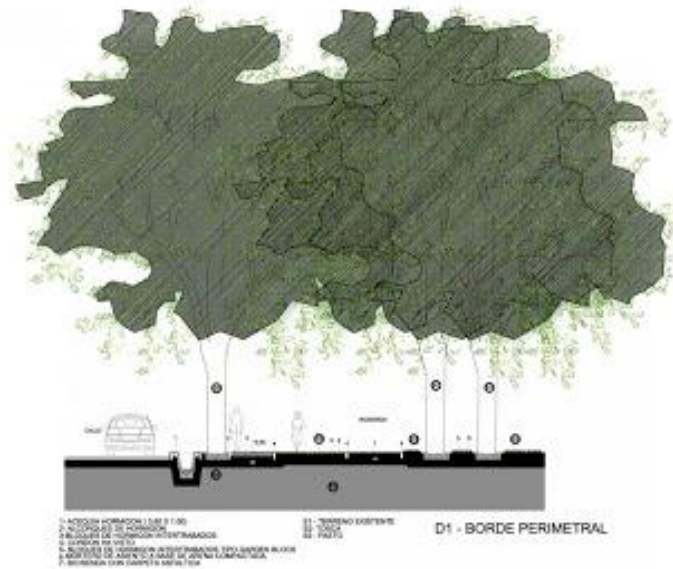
Corte de Detalle del Parque Central de Mendoza, Fuente: archdaily.mx (Agosto, 2019)
